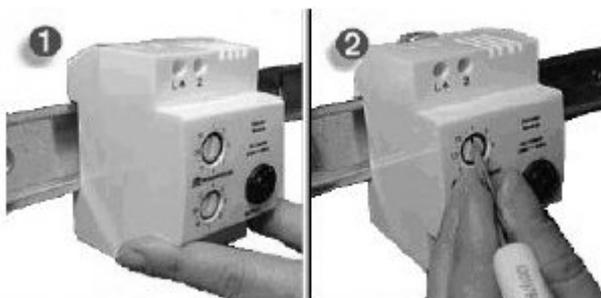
Pasos para la instalación del módulo con dimmer carril DIN.
